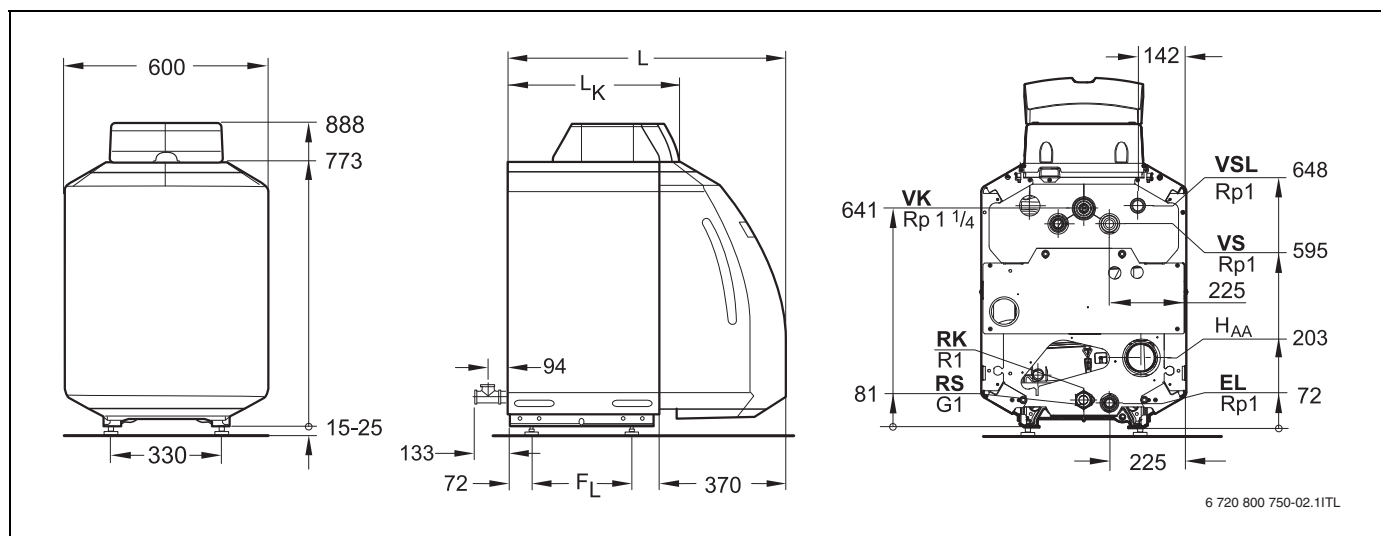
Conexiones y dimensiones (dimensiones en mm)
